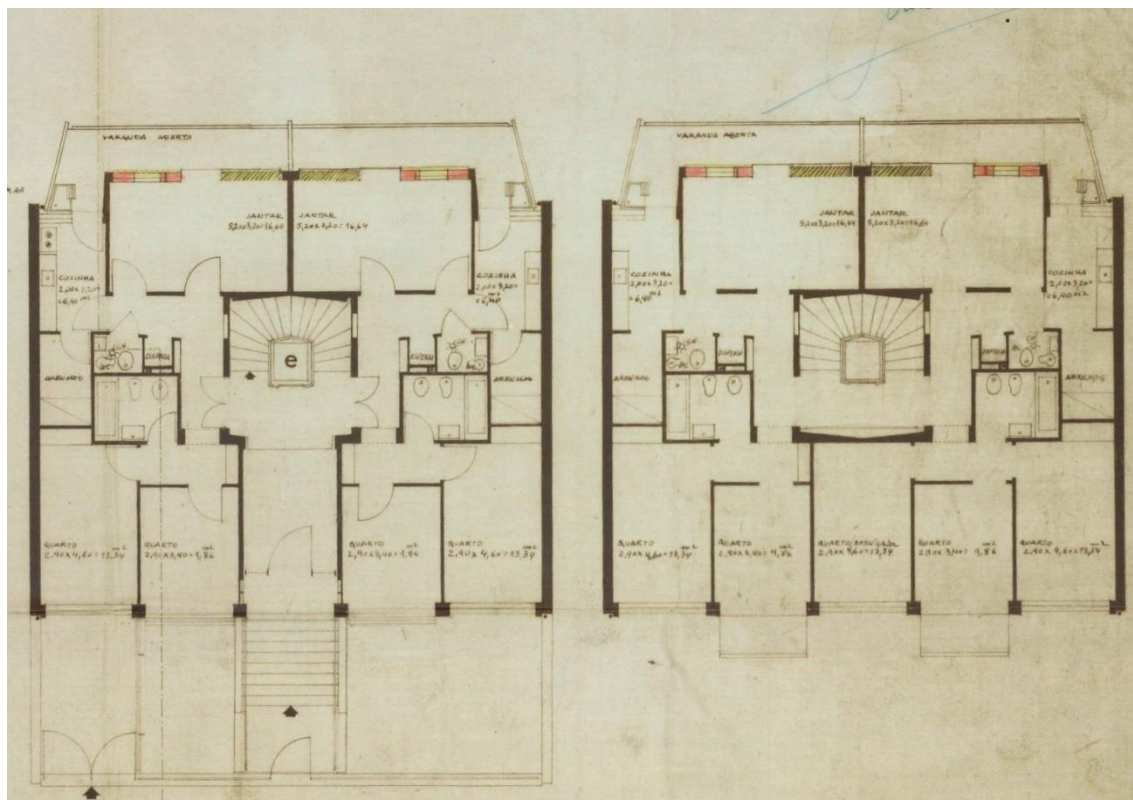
Planta do 3º piso, nível de entrada no prédio e Planta dos pisos 4º, 5º e 6º.
